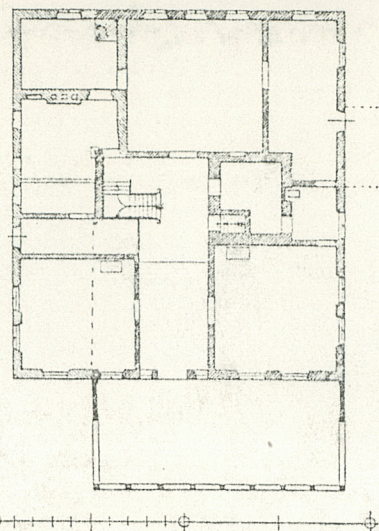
Heutiger Grundriß des früher Zimmermannschen Hauses zu Klettendorf.
